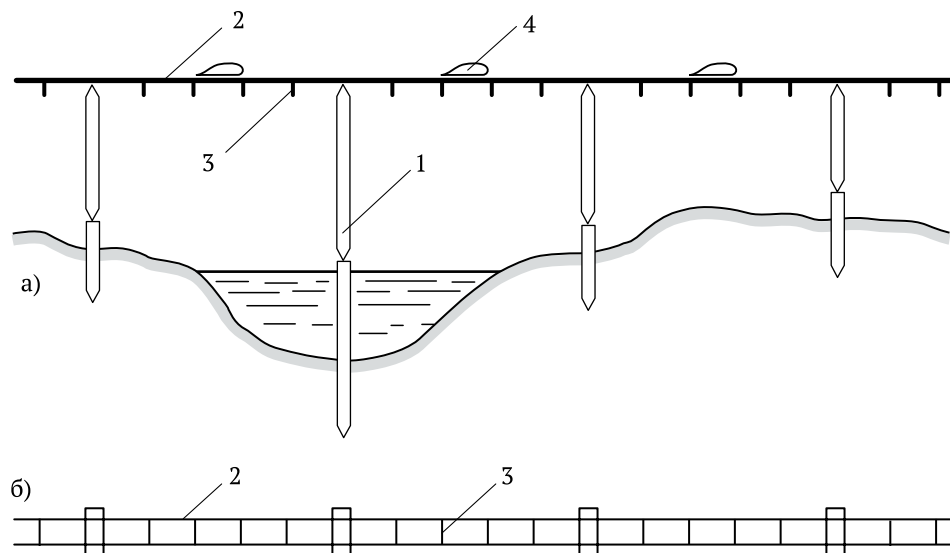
Схема размещения поперечных планок по длине трассы: а – вид сбоку на СТС; б – вид сверху на СТС; 1 – поддерживающая опора; 2 – рельс; 3 – поперечная планка; 4 – транспортный модуль
